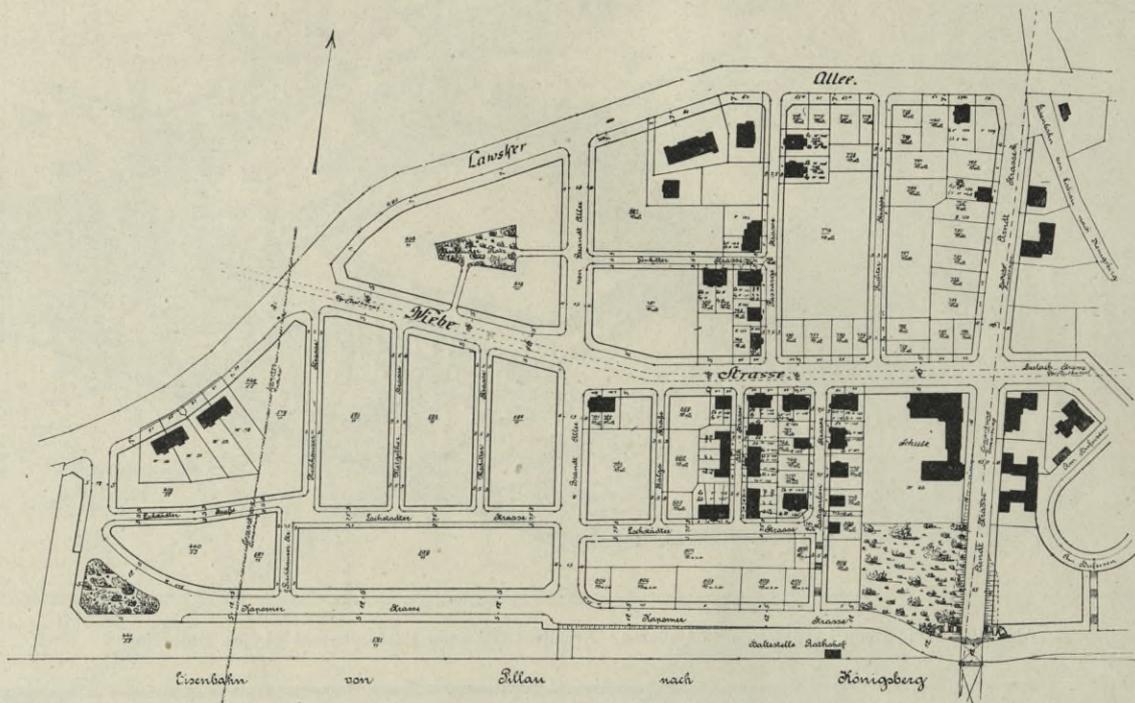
Lageplan der Gartenstadt Ratshof bei Königsberg i. Pr.
